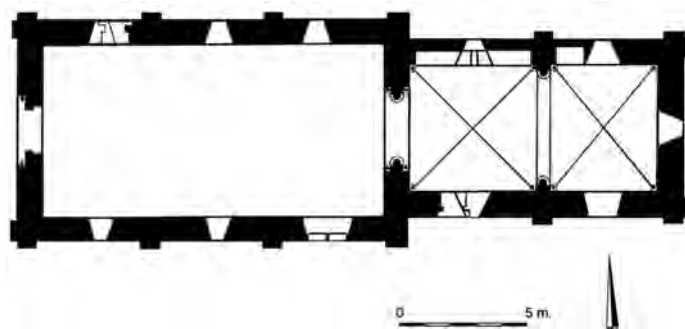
Plan de l'église Notre-Dame de Sainte-Marie-aux-Anglais au Mesnil-Mauger (Calvados).
